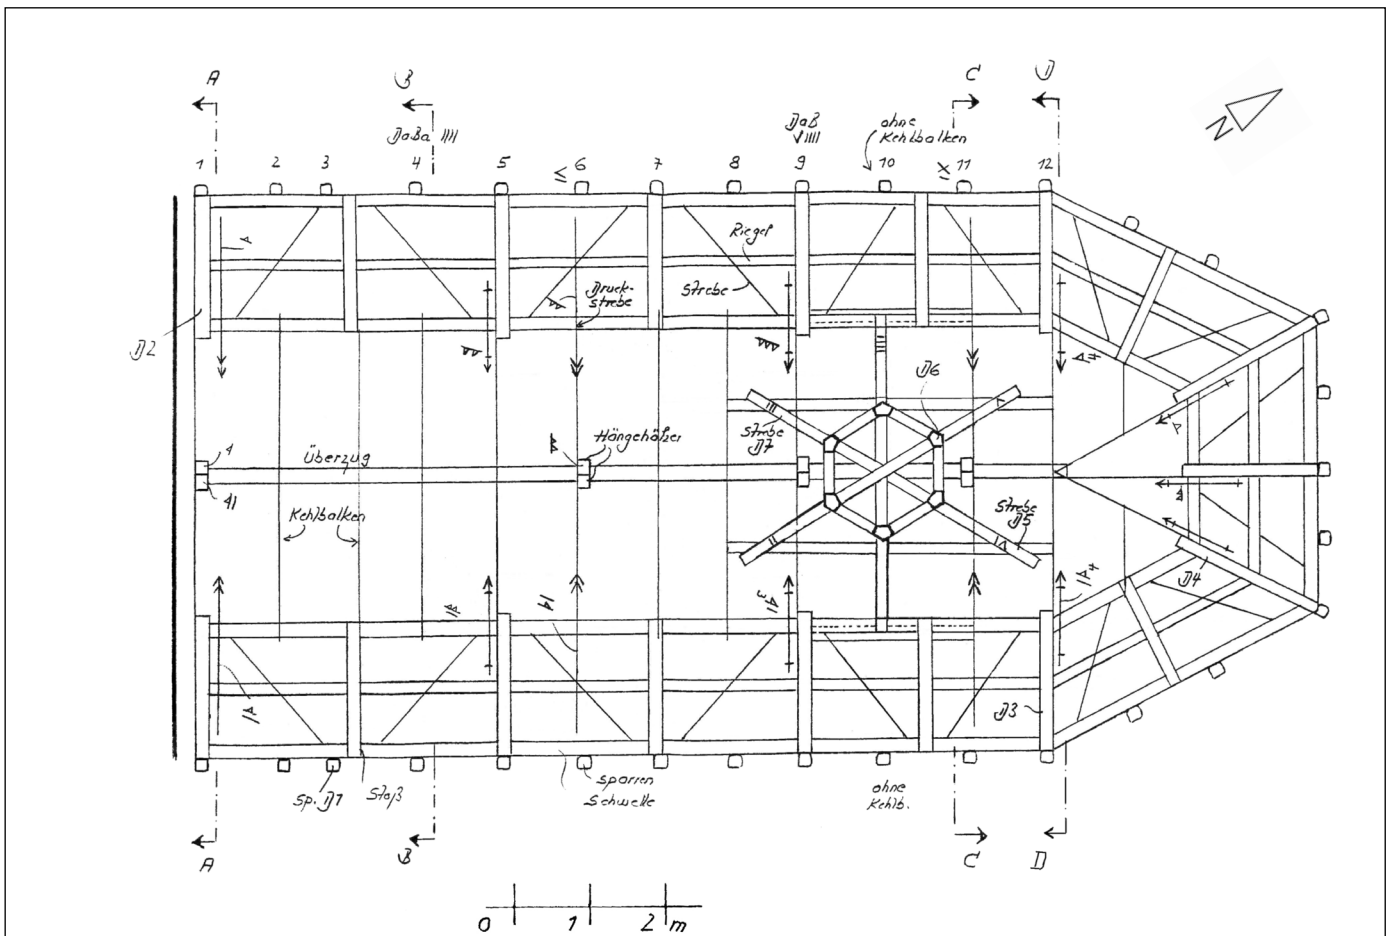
Wettelbrunnerstraße 17, Sebastianskapelle, Grundriss Dachwerk.
